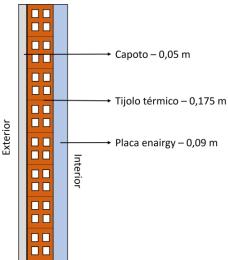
Corte transversal das paredes exteriores (não se encontra à escala)
